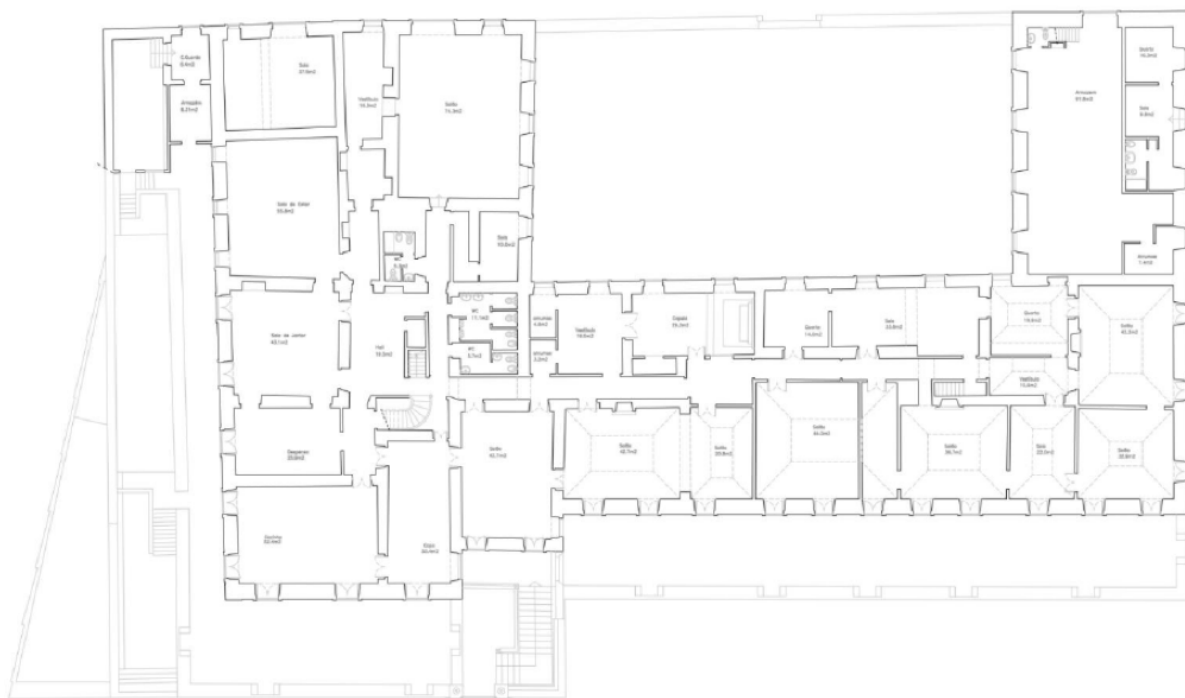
Planta original do piso I da Casa do Governador; sem escala
